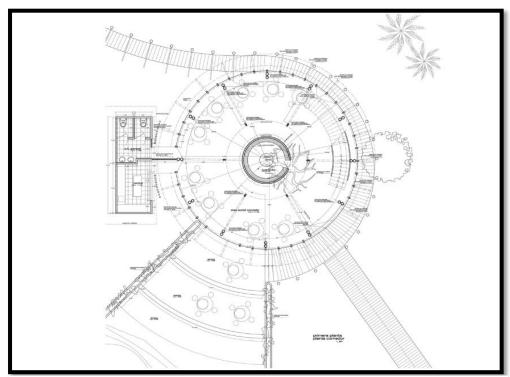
Planta de primer nivel de la recepción. Fuente: Archdaily
